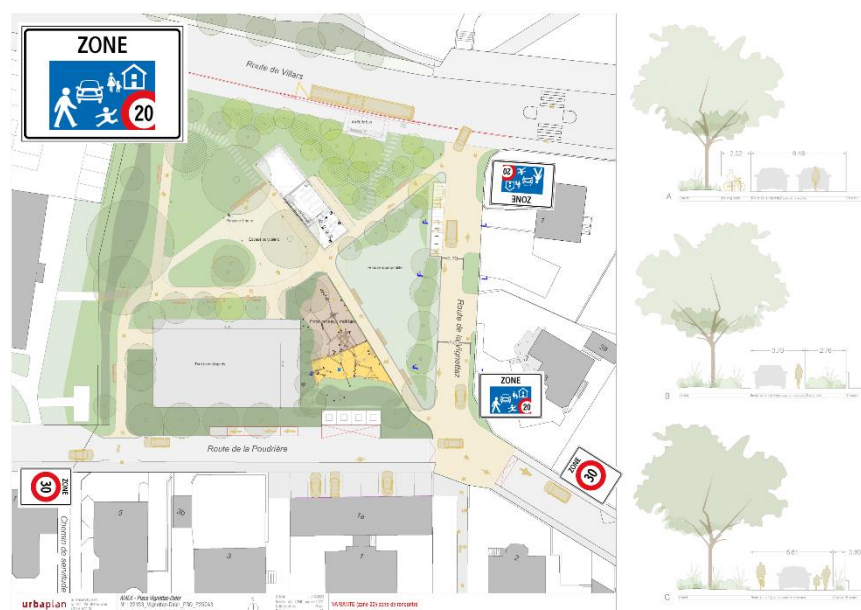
Plan d'aménagement avec la route de la Vignettaz en zone 20km/h (zone de rencontre)
